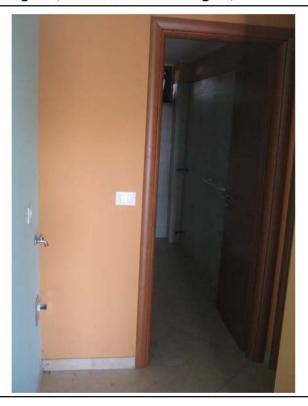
Vista ripostiglio (locale adibito a bagno)
